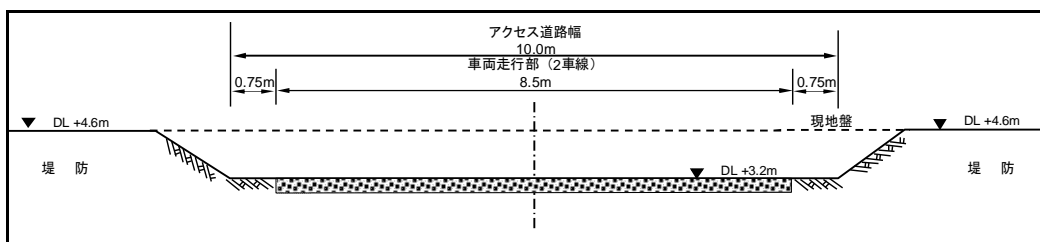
北側アクセス道路の堤防部の横断面図
